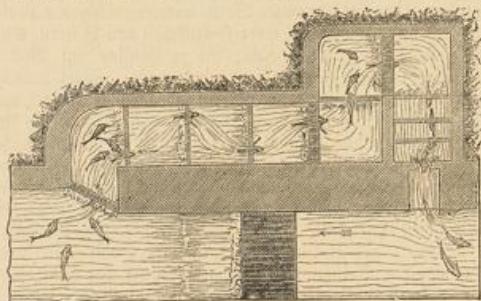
Cail'sche Fischtreppen: Grundriss.
